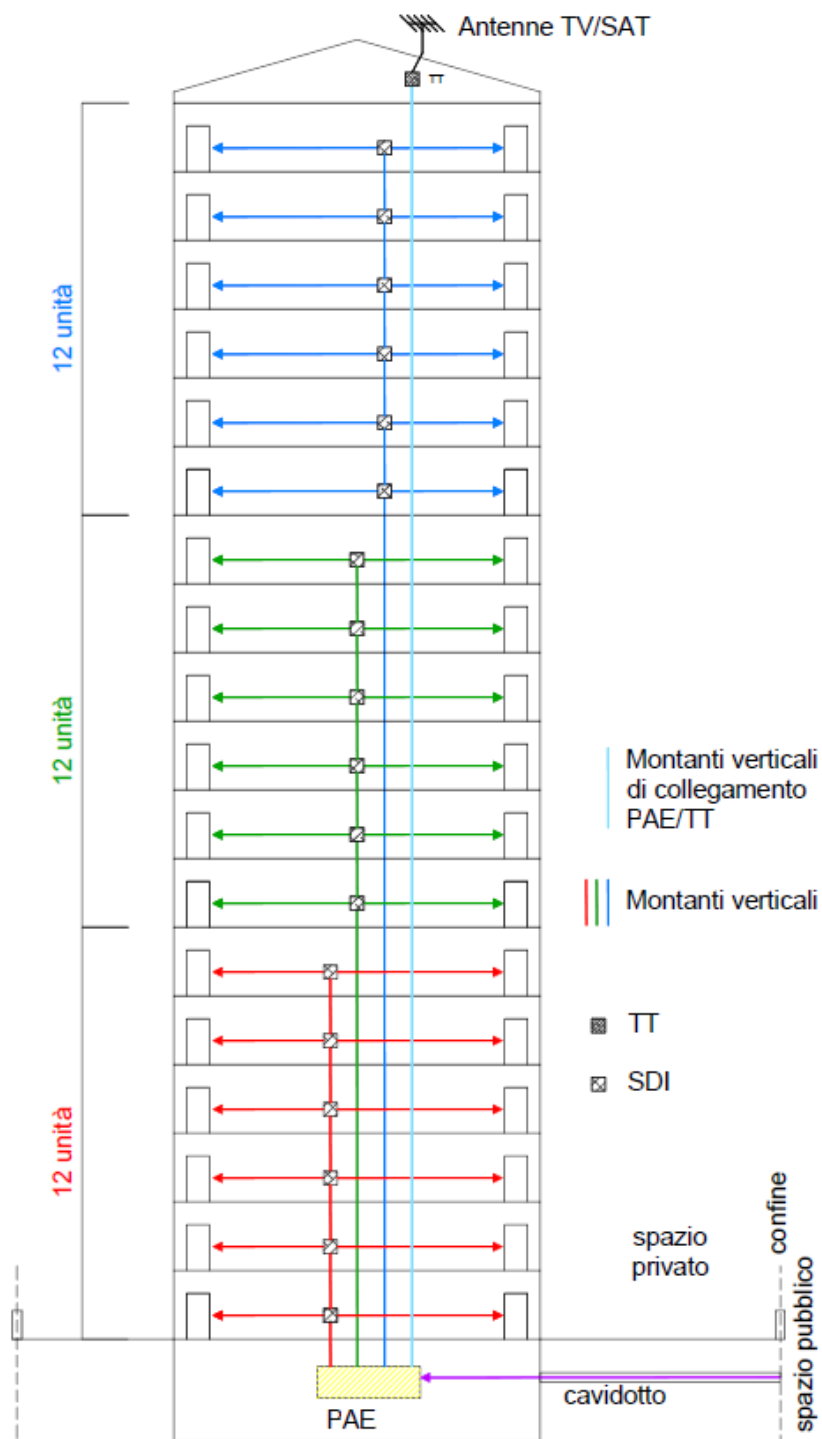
Esempio 1, elevato numero di piani e pochi utenti per piano
